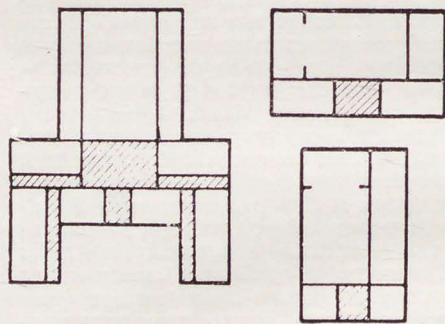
Слева — схема плана зданий клуба, Дворца культуры; справа — схема плана здания клуба
